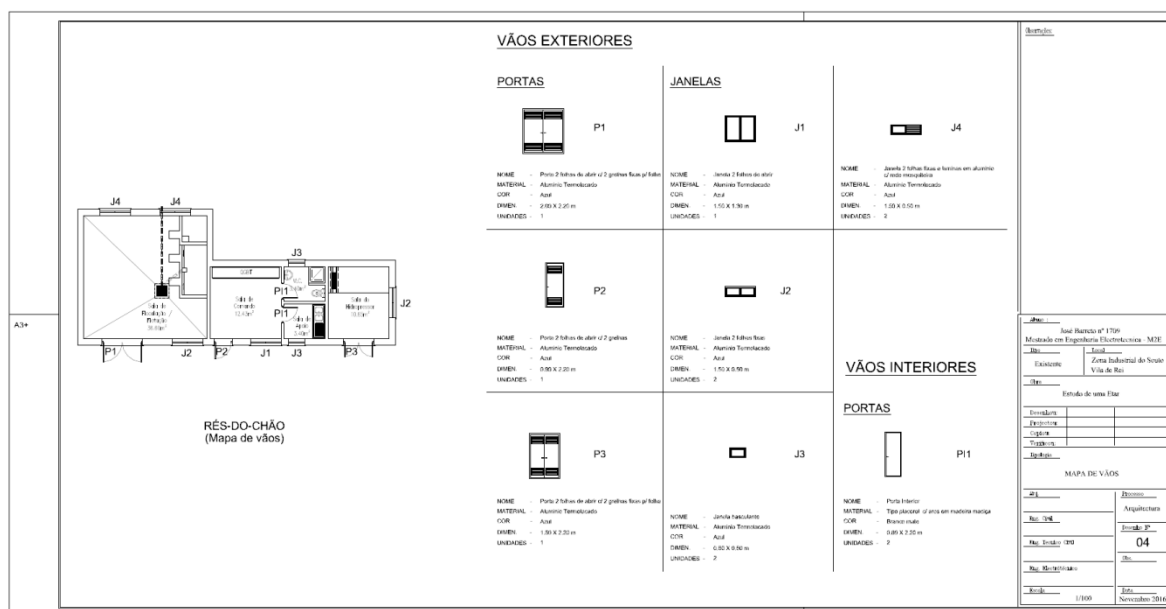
Planta de mapa de vãos e exteriores e interiores
